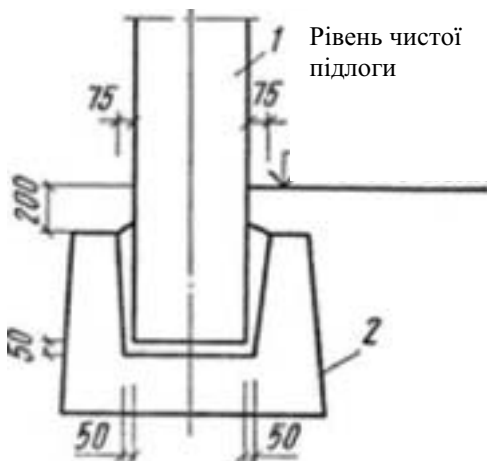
Вузол сполучення стінової панелі з лотковим фундаментом: 1 – колона; 2 – лотковий фундамент.
